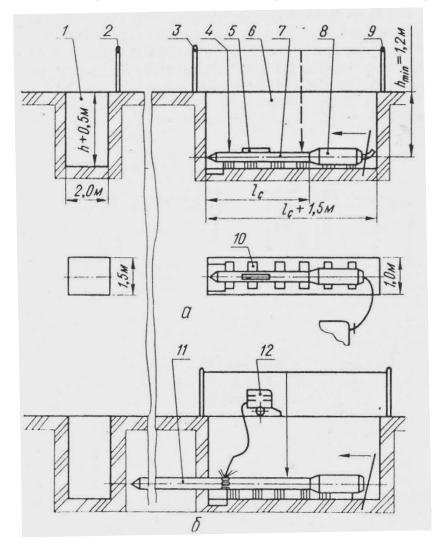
Схема производства работ при забивании труб 1 - приемный приямок; 2,3,9 - колышки; 4 - отвес; 5 - уровень; 6 - входной приямок; 7,11 - труба; 8 - пробойник; 10 - брусок; 12 - сварочный аппарат.
